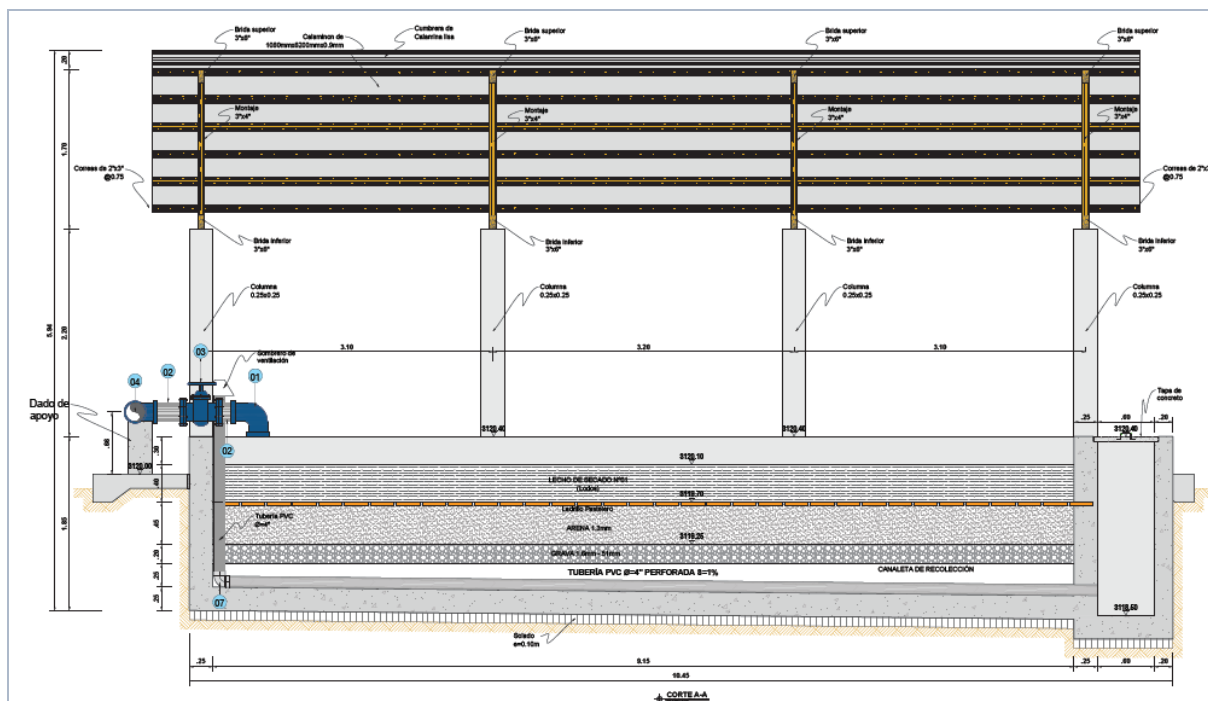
DETALLE DE LECHO DE SECADO PERFIL
